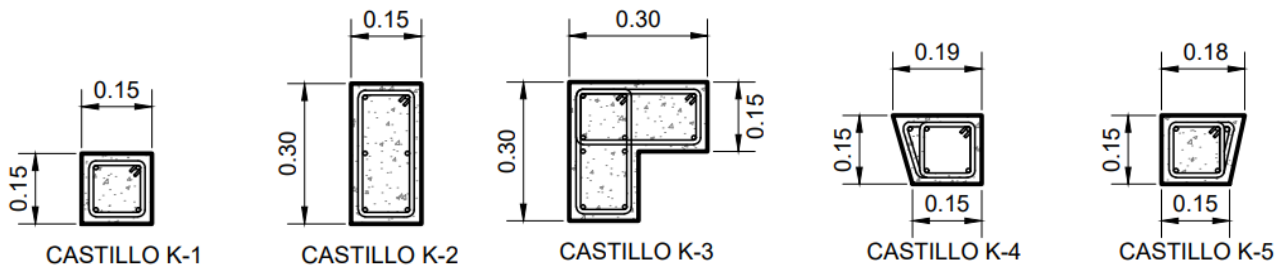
Detalles estructurales; elaboración propia, 2023.
